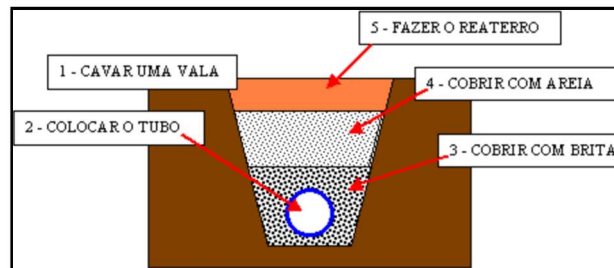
Foto ilustrativa de tubo de drenagem a ser executado
